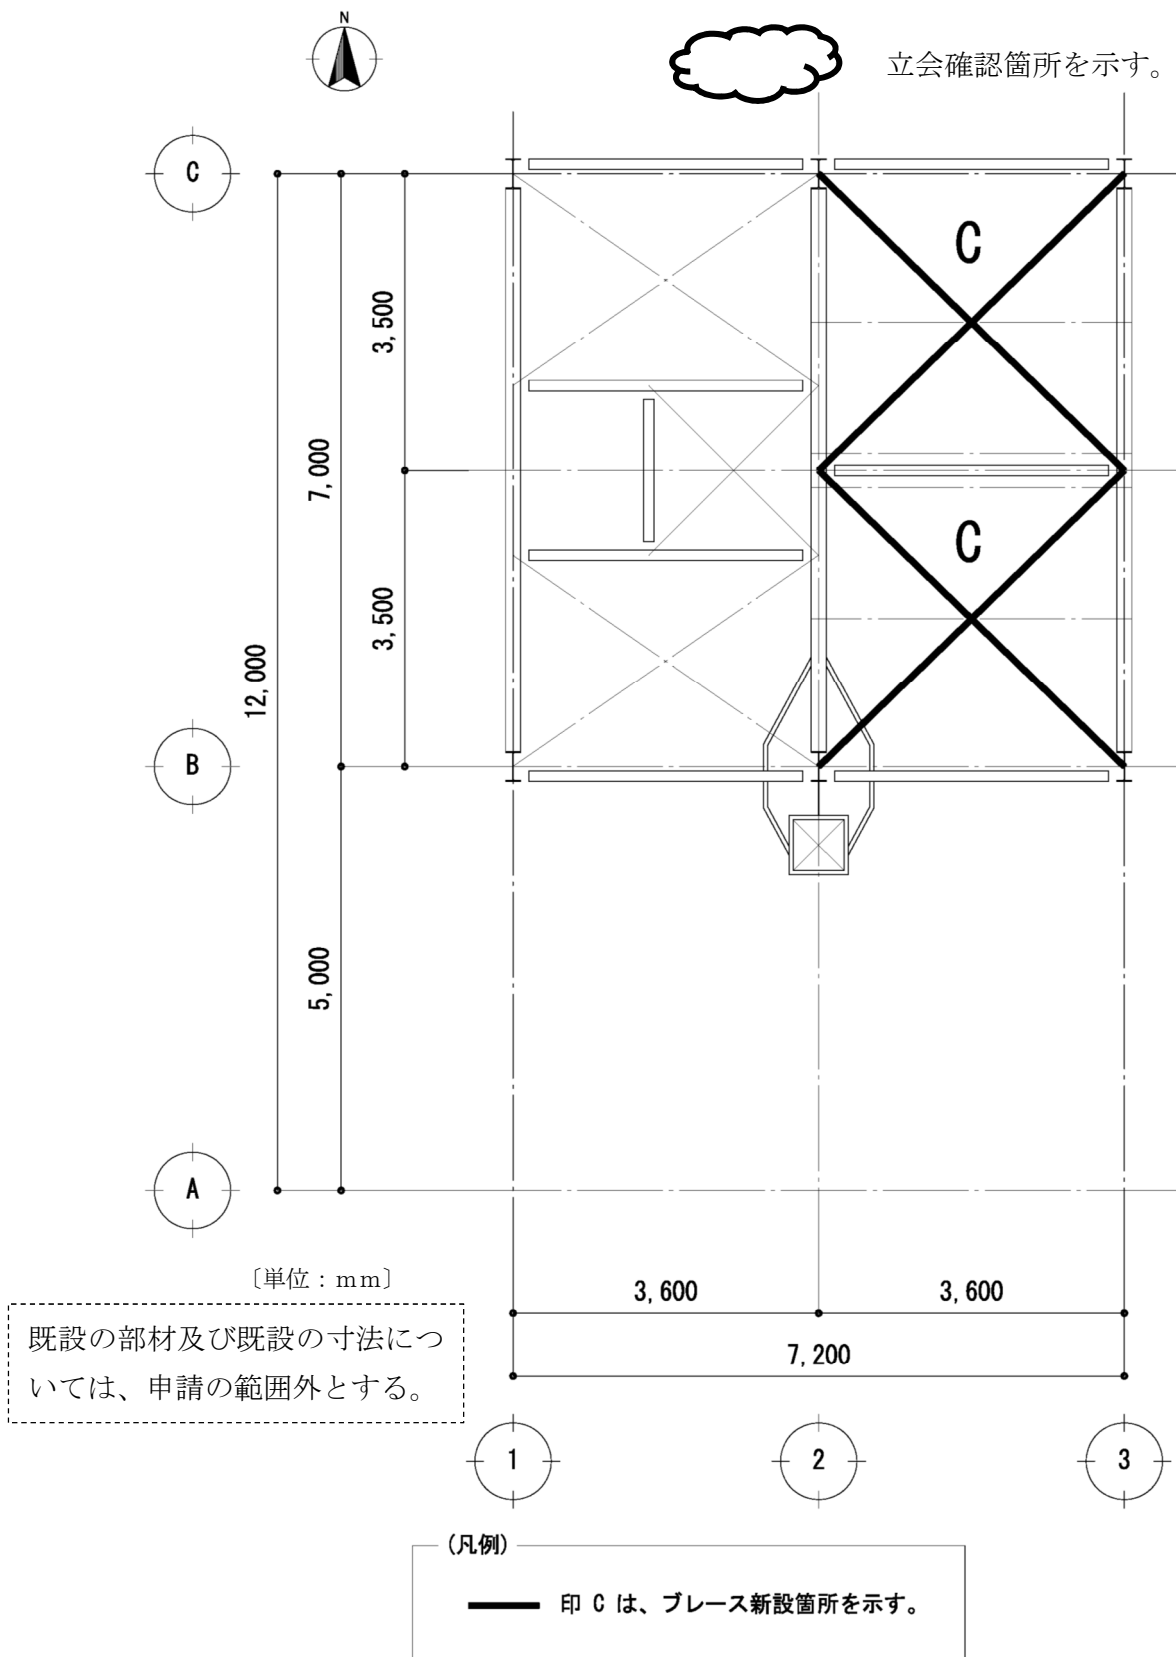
燃料棟 屋根伏図 (R3 レベル)
